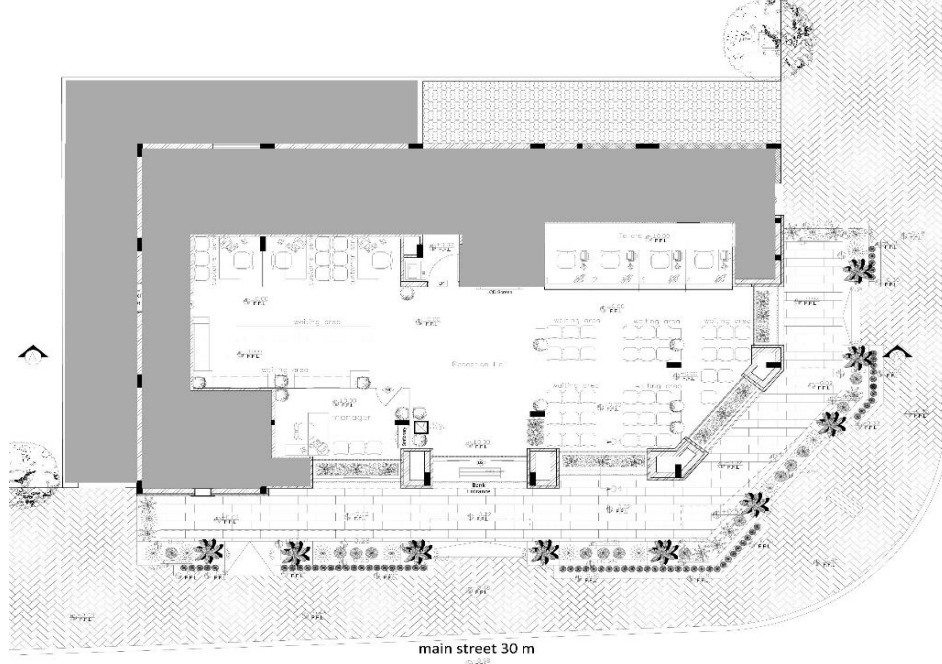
المسقط الافقي للطابق الارضي لمكتب تل الهوى
